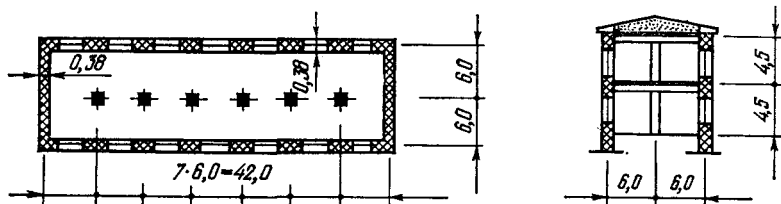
План и разрез двухэтажного кирпичного здания.
